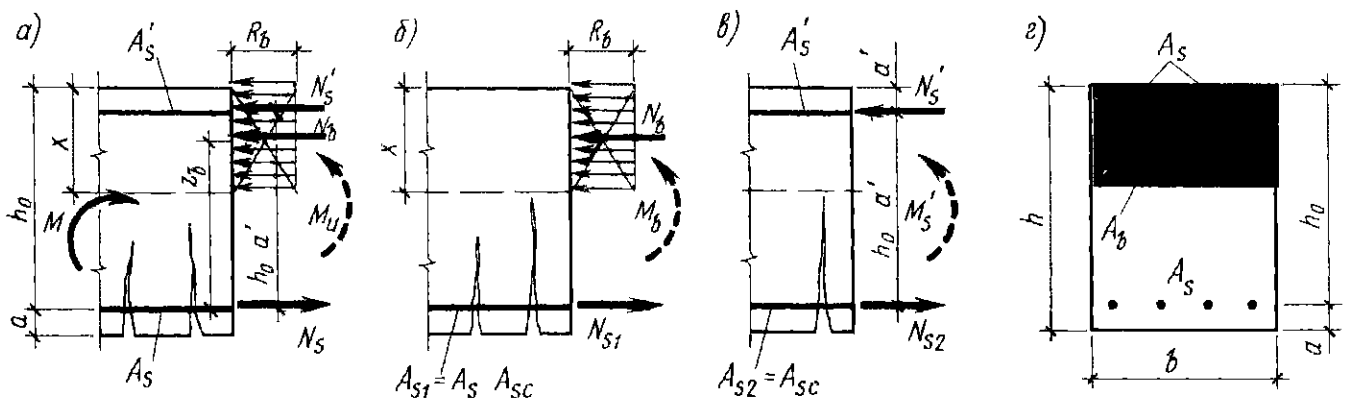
Схема усилий и напряжений в нормальном расчетном сечении прямоугольных элементов с двойной арматурой
